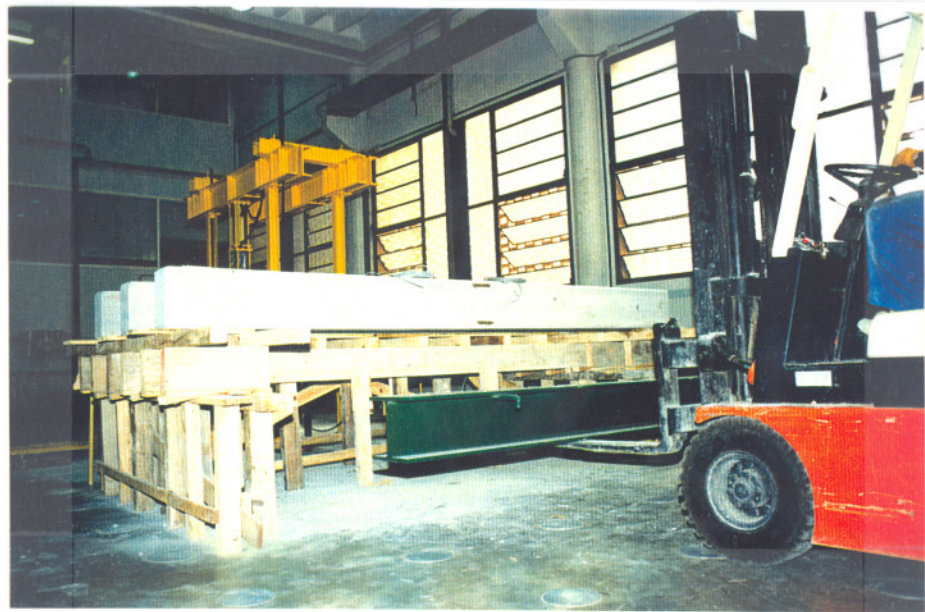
El día siguiente al hormigonado se procedió a retirar los encofrados laterales de las vigas, dejando las cimbras hasta el momento del ensayo.
